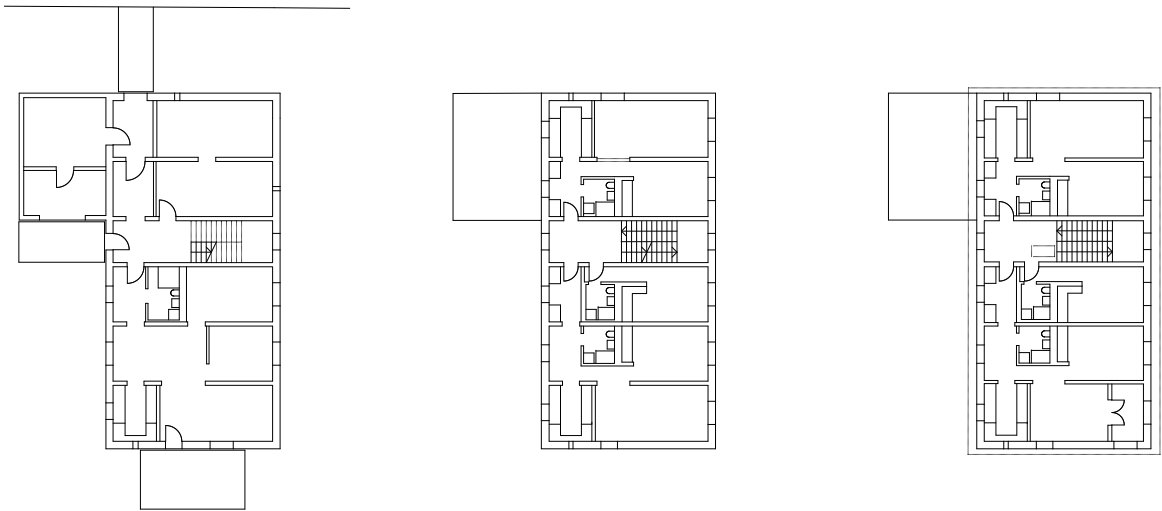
, Grundrisse Gebäude in Bad Aibling, von links nach rechts: Erdgeschoss, 1. Obergeschoss, 2. Obergeschoss, Quelle: Florian Nagler Architekten
